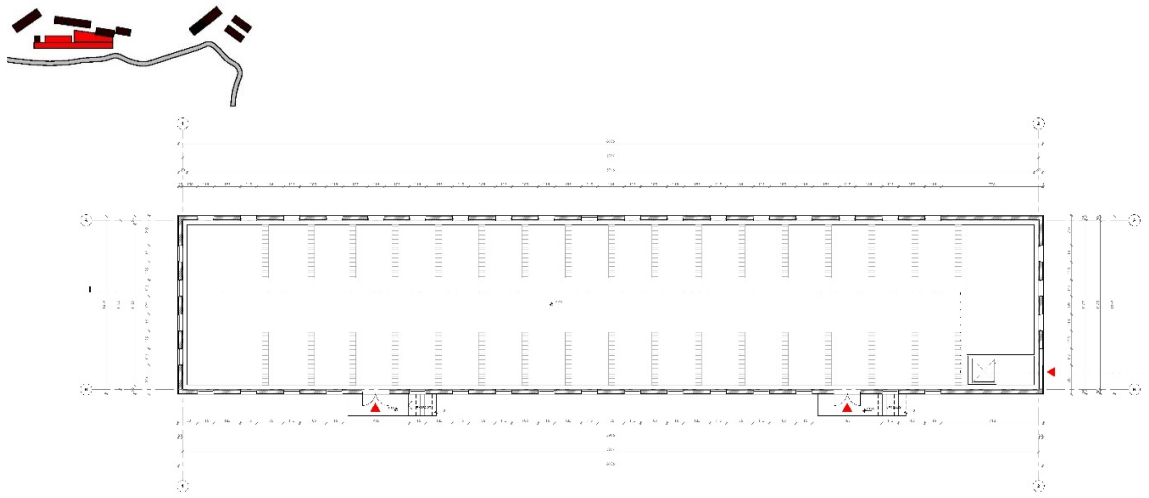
Objekti 4 - Planimetria e objektit ekzistues
